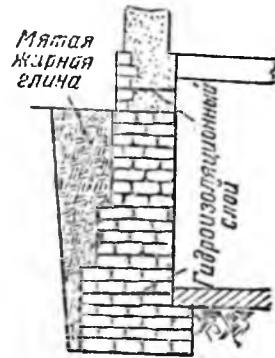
Гидроизоляция стен подвального этажа двумя гидроизоляционными слоями и мягкой глиной
